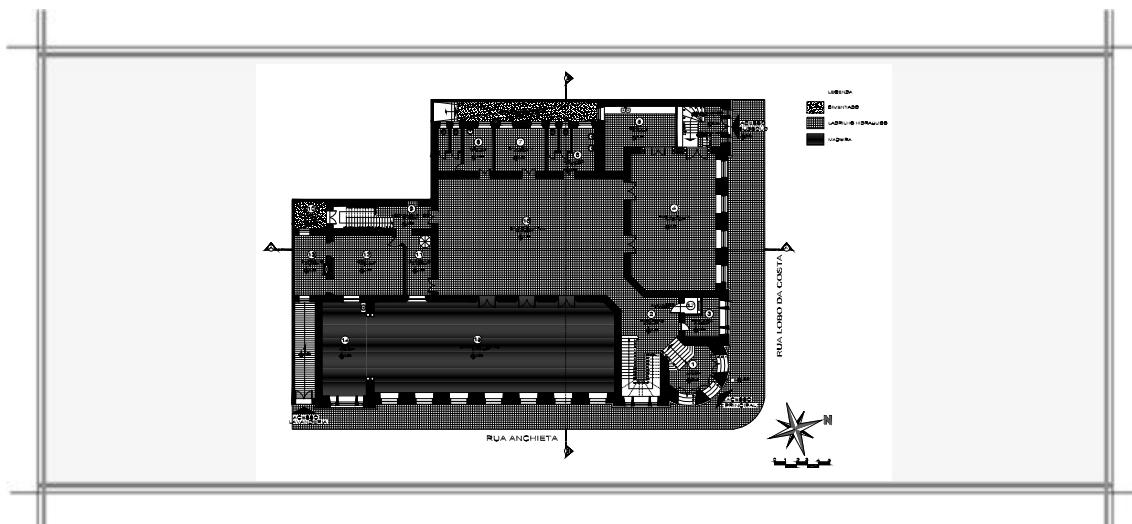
Planta Baixa do 1º Pavimento. Desenho: Cristiane Müller.
